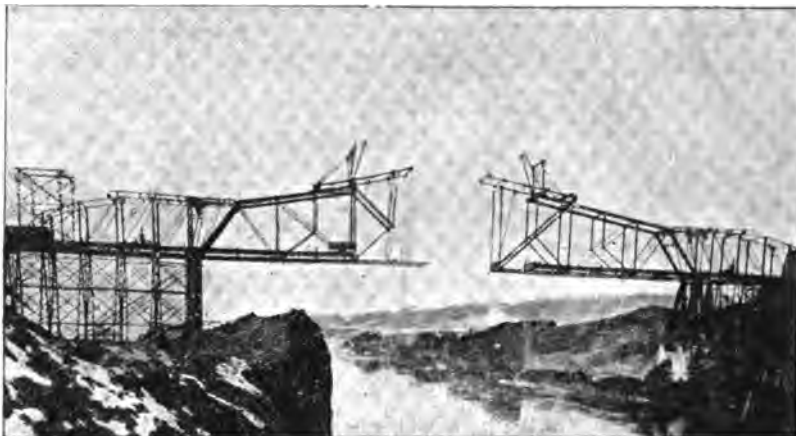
Montage en porte-à-faux d'une travée indépendante de 126^m,95 de portée, sur la Colombie¹ (Edge Moor Bridge Co).
